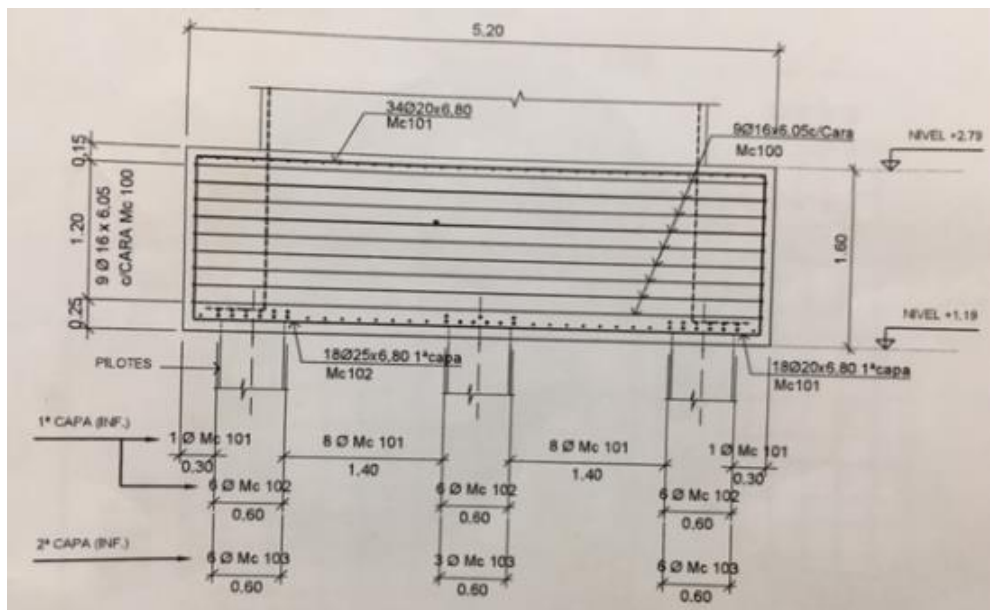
Armado de acero de cabezal de la pila P.16-17
